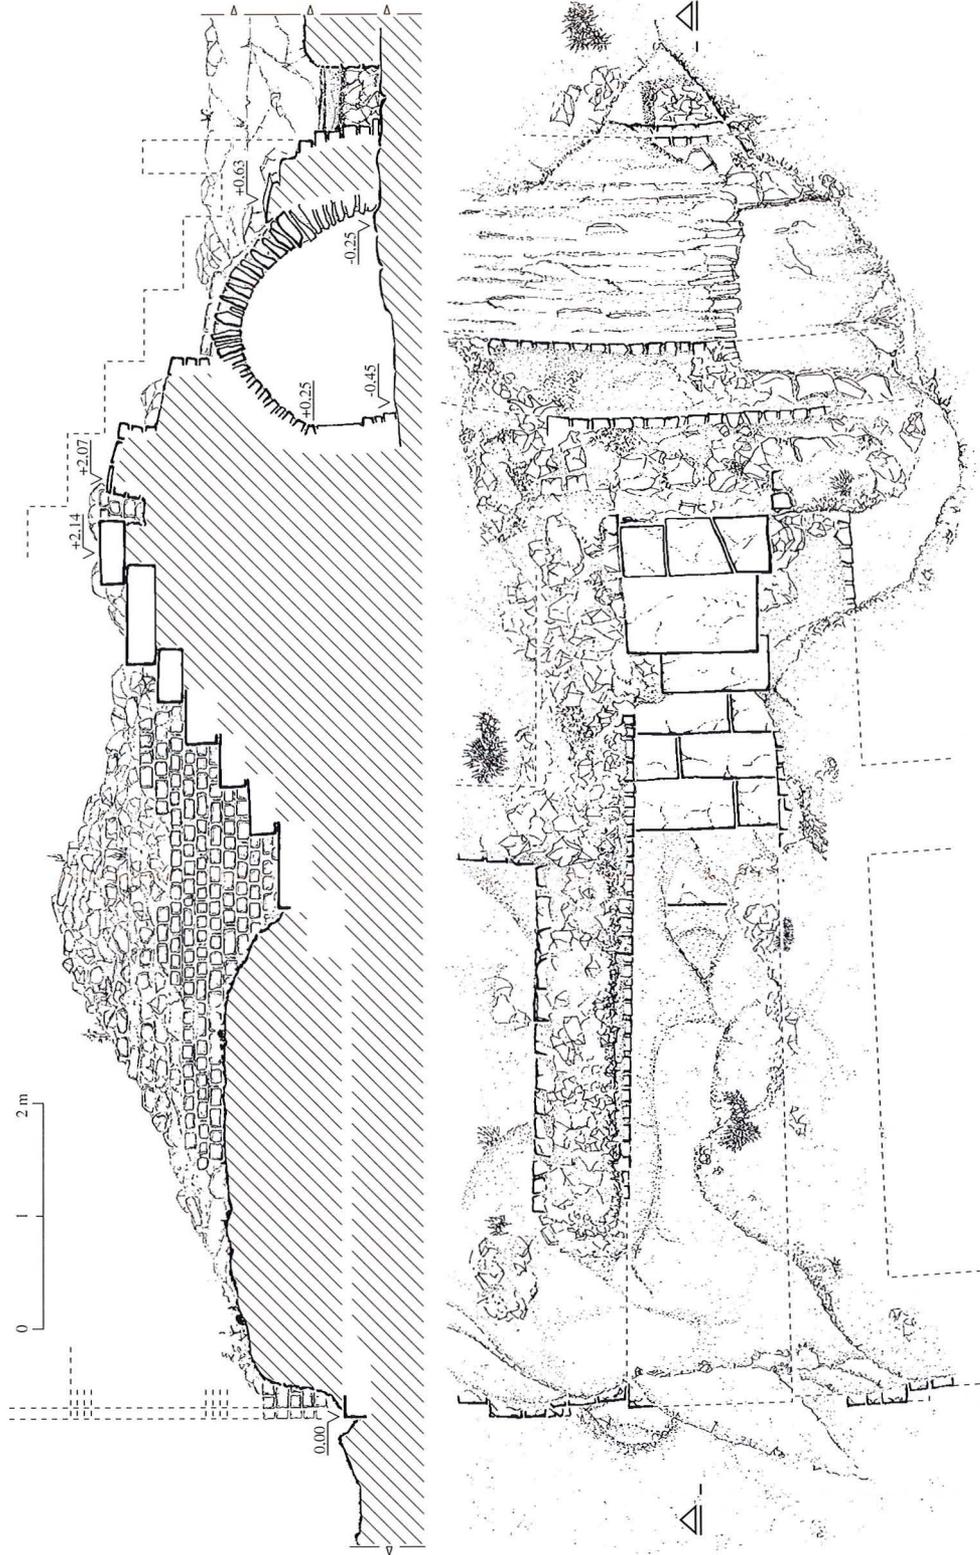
Plan et coupe longitudinale du vomitoire V3.
